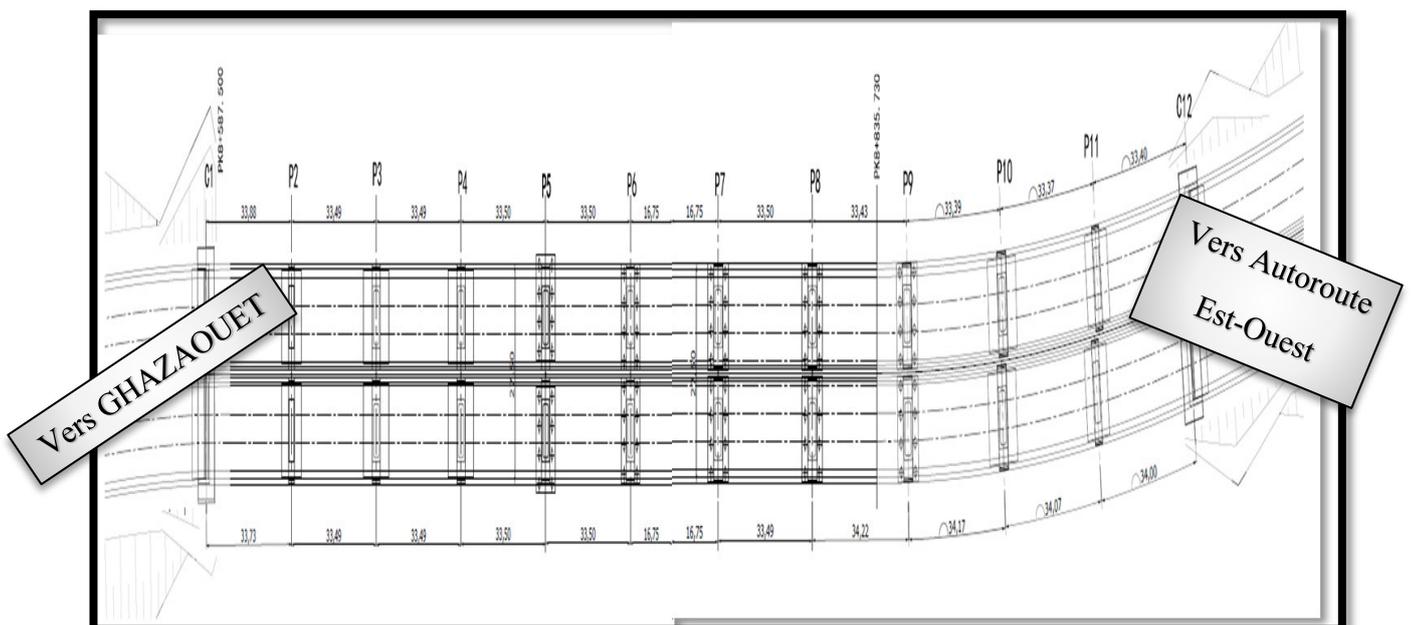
Vue en plan échelle 1/750 de l'ouvrage d'art PK8+762
